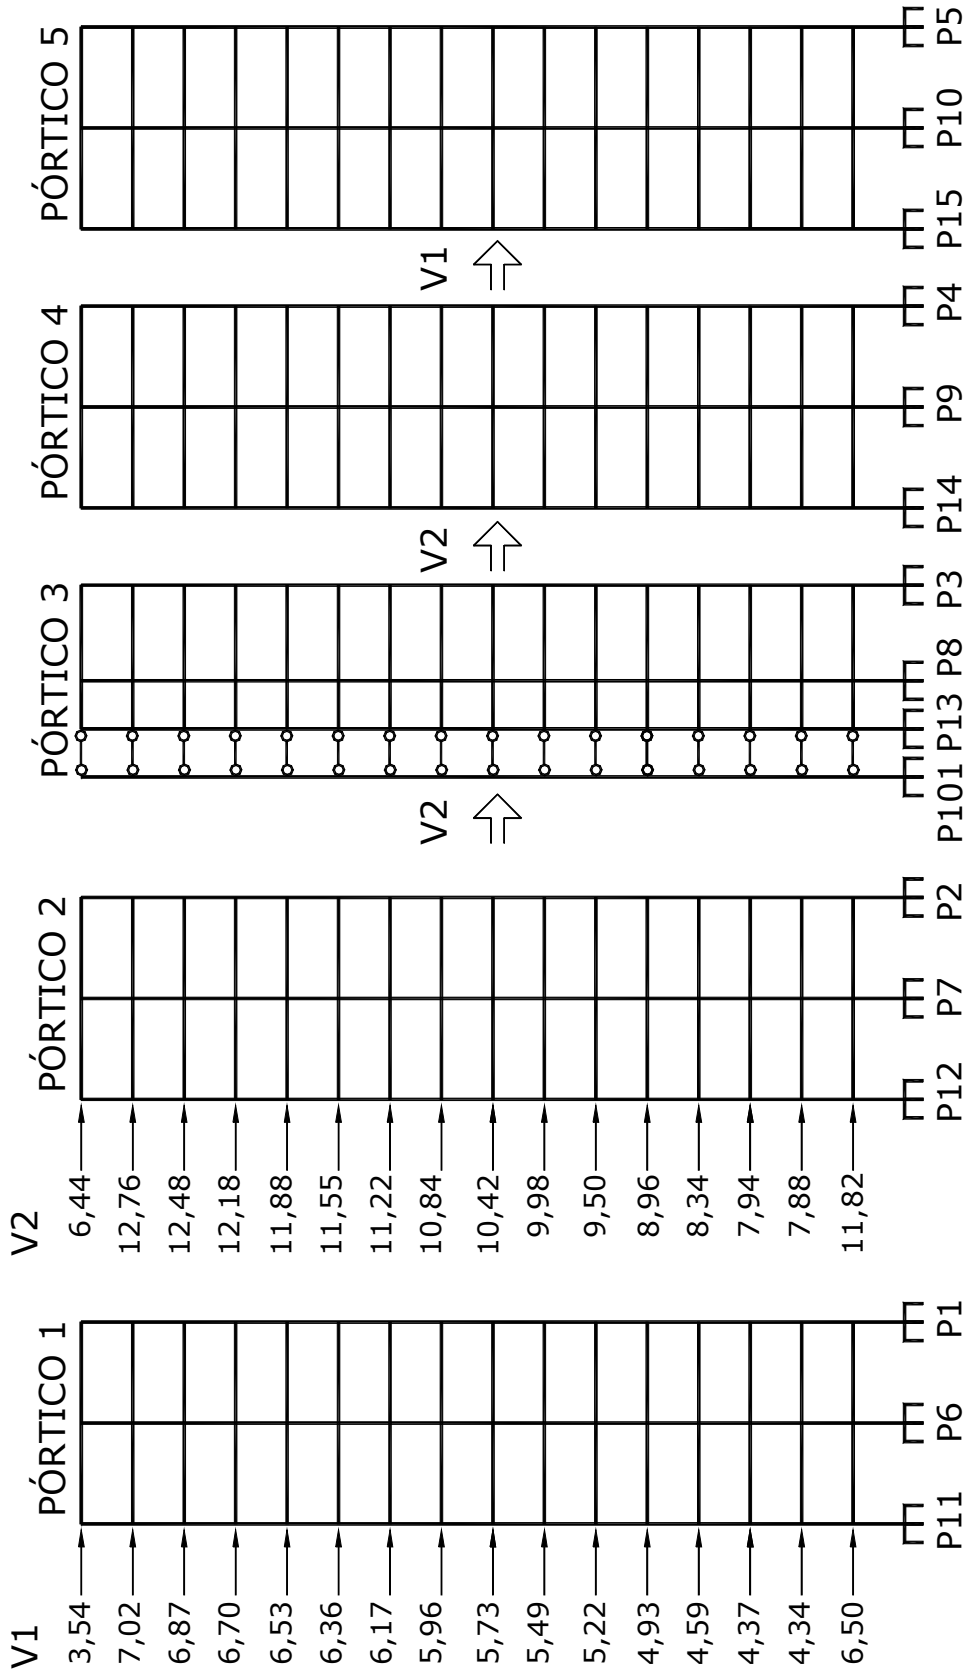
Modelo Pórticos Planos Independentes com Áreas de Influência (PPI-AI) da Estrutura 3: elevação dos pórticos e esquema do carregamento (em kN).
